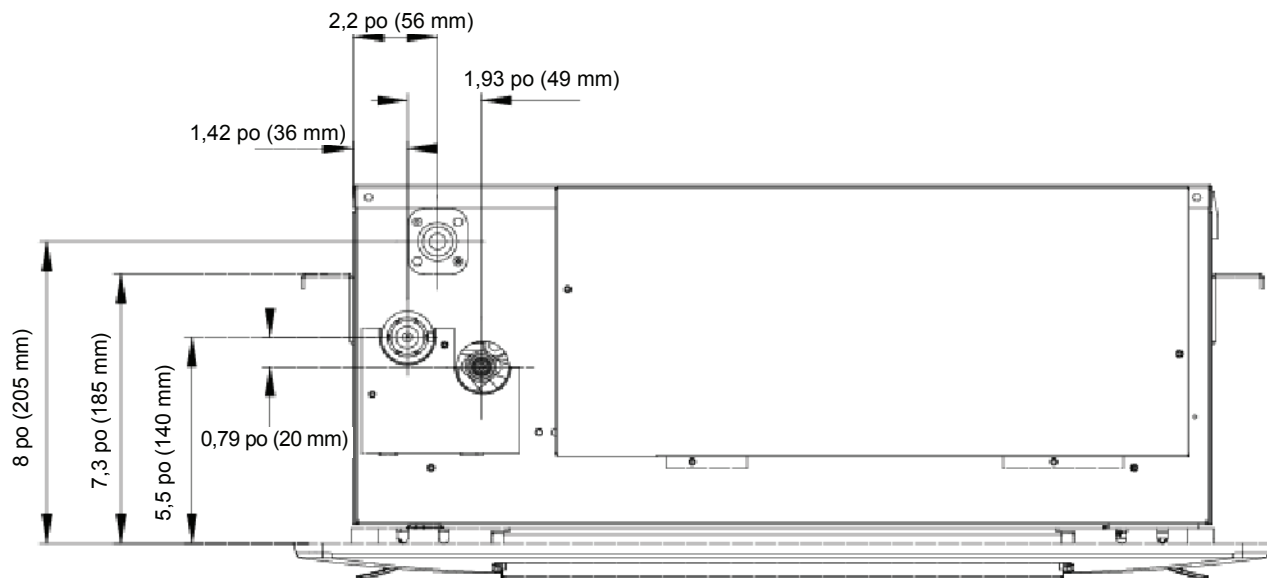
Dimensions – vue latérale des raccords de la cassette
